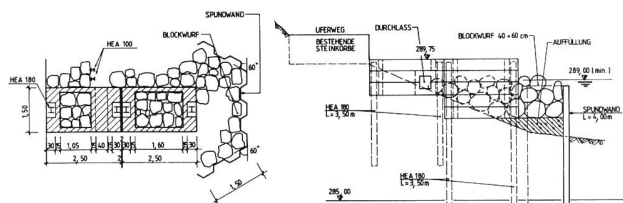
Grundriss und Querschnitt durch eine zweifeldrige Buhne.
